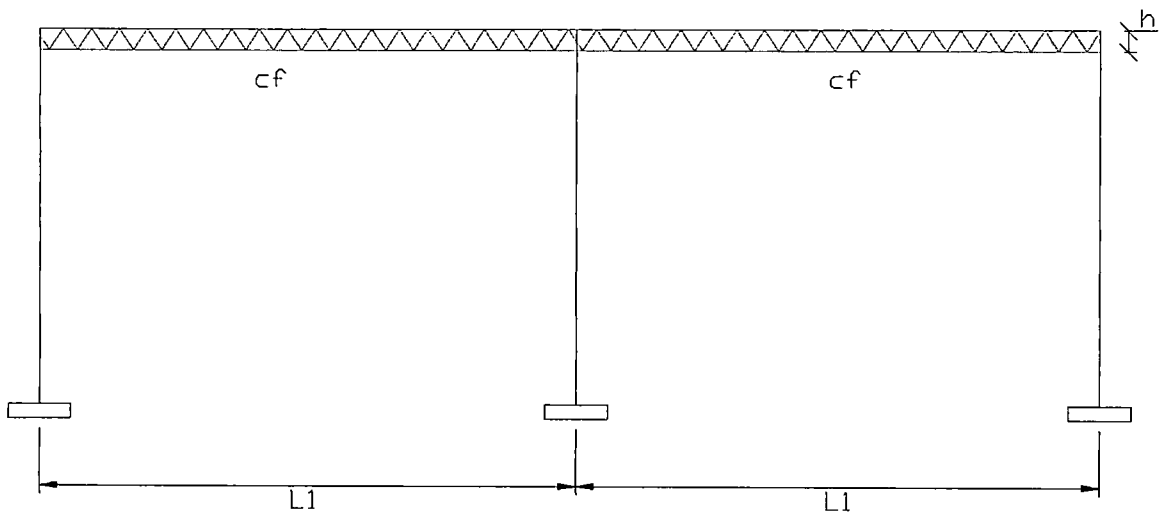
Vista en Elevación Típica de un Techo Continuo
